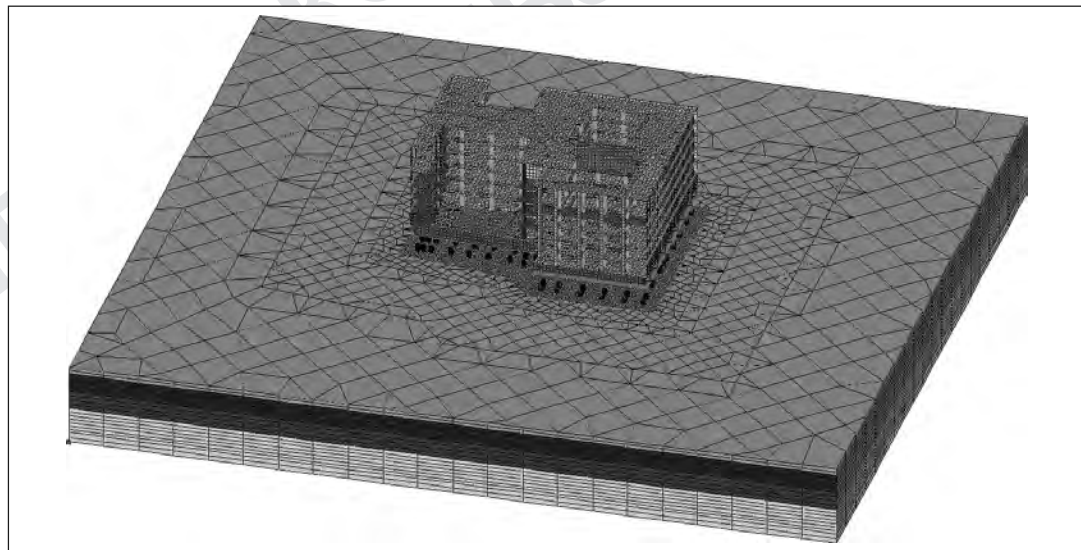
Расчетная схема «здание — подземное сооружение — свайные фундаменты — основание»
